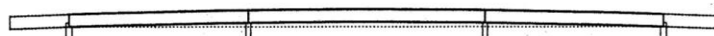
Profilage longitudinal d'un pont ou viaduc
